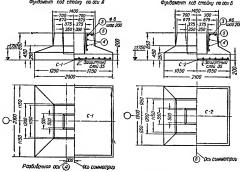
Конструкция фундаментов под стойки по осям А и Б.
